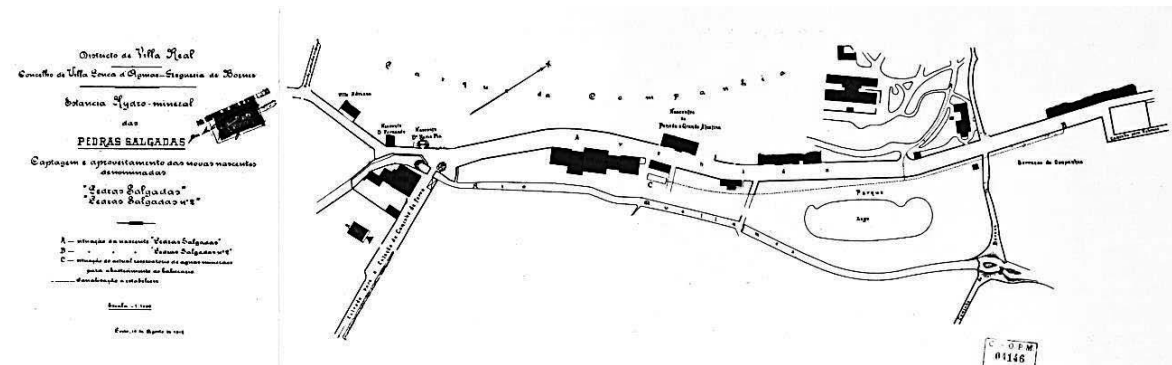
Termas de Pedras Salgadas, planta de localização, 1912
